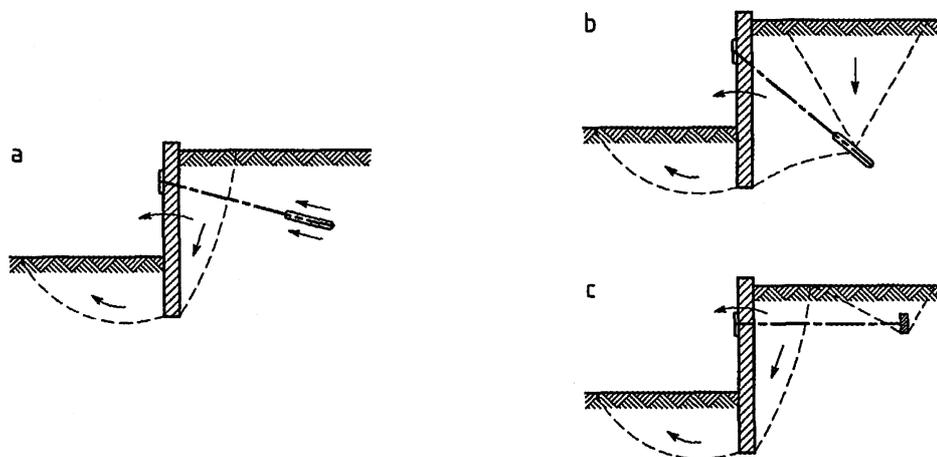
Exemples de modes limites pour la rupture par arrachement des ancrages
